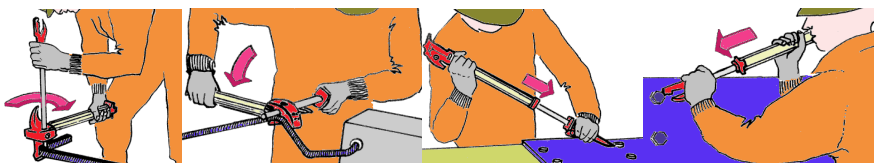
з. Гибка профильного металла; обрубка болтов; ослабление гаек
